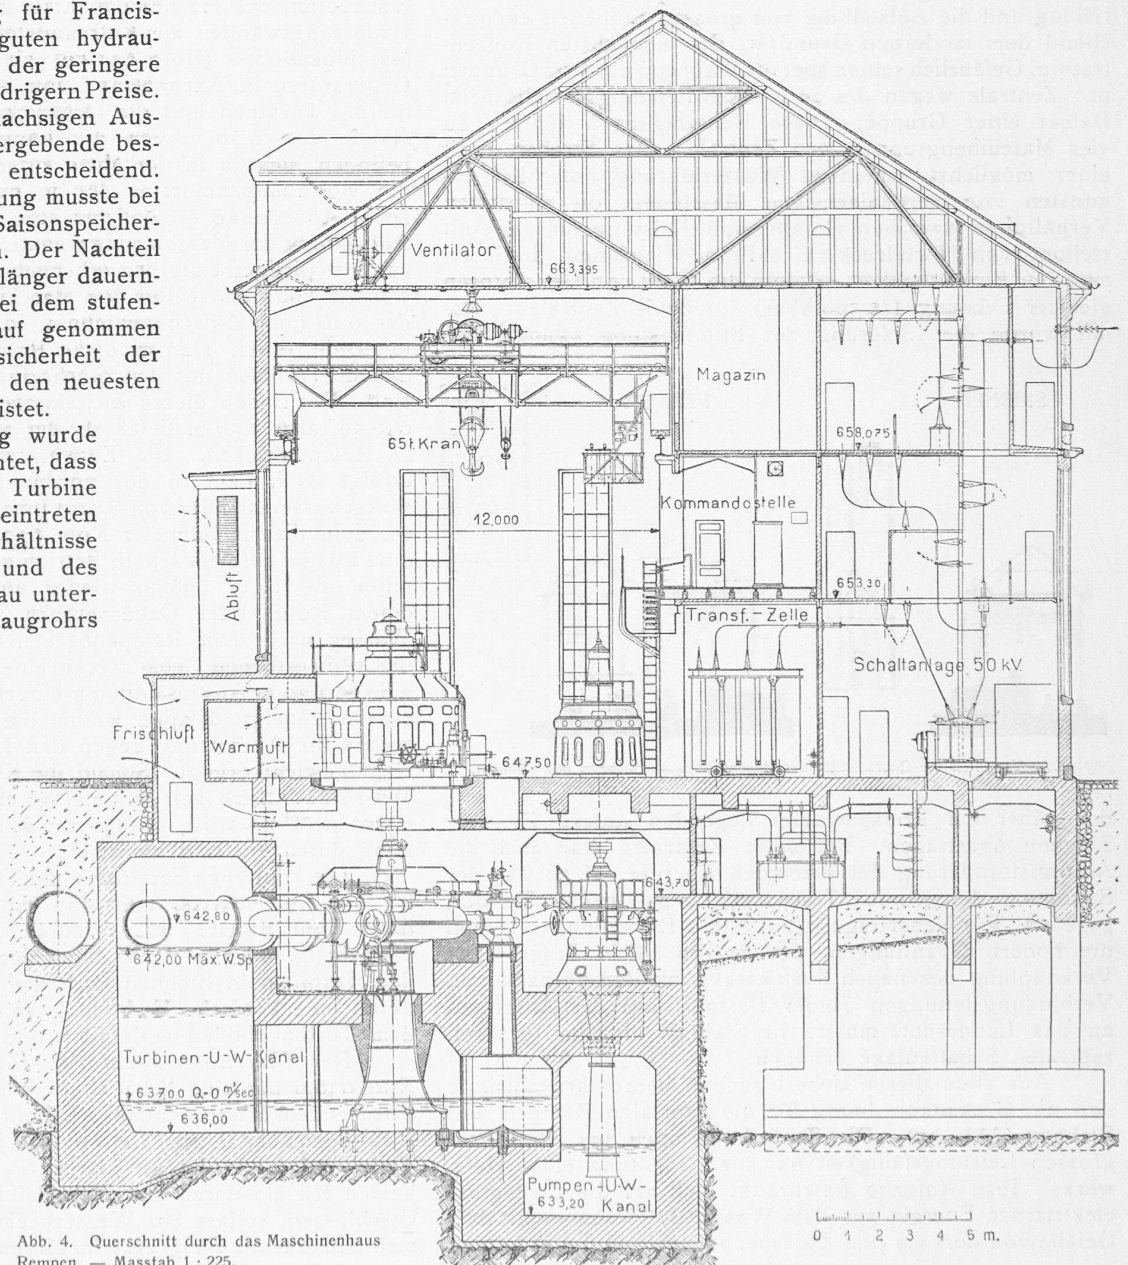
Querschnitt durch das Maschinenhaus Rempen. — Masstab 1 : 225.
